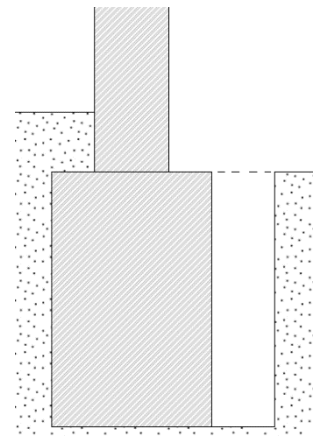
Excavación de la zanja adosada a la cimentación, se deberá procurar que las paredes de la zanja queden verticales. Fuente: Elaboración propia.
